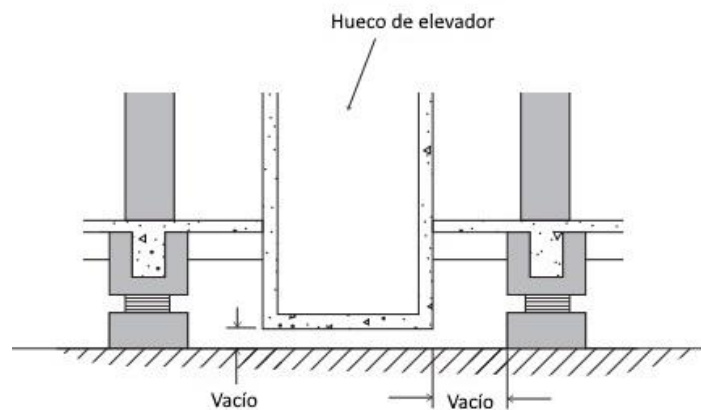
Corte transversal al plano de aislamiento donde se ve que el hueco del ascensor cuelga de la estructura aislada. (Charleson y Guisasola, 2017).
